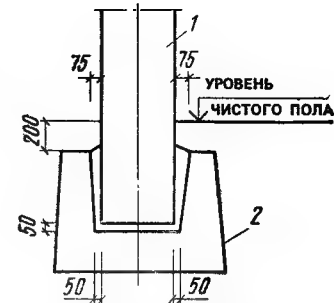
Узел сопряжения стеновой панели с лотковым фундаментом
